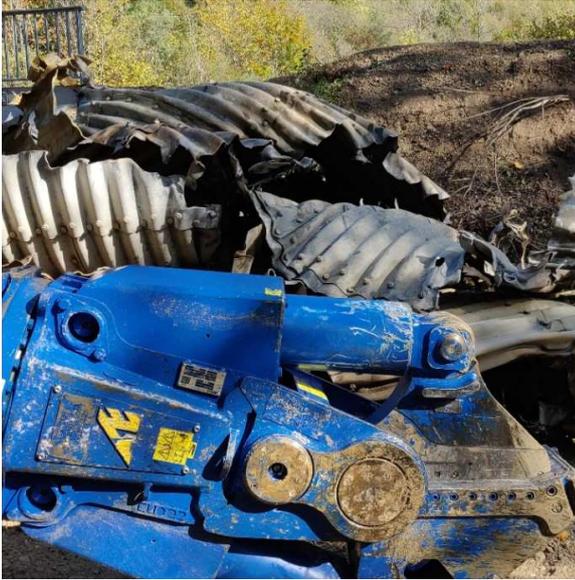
planche photos du déroulement des travaux de suppression de la buse de Tacon.
